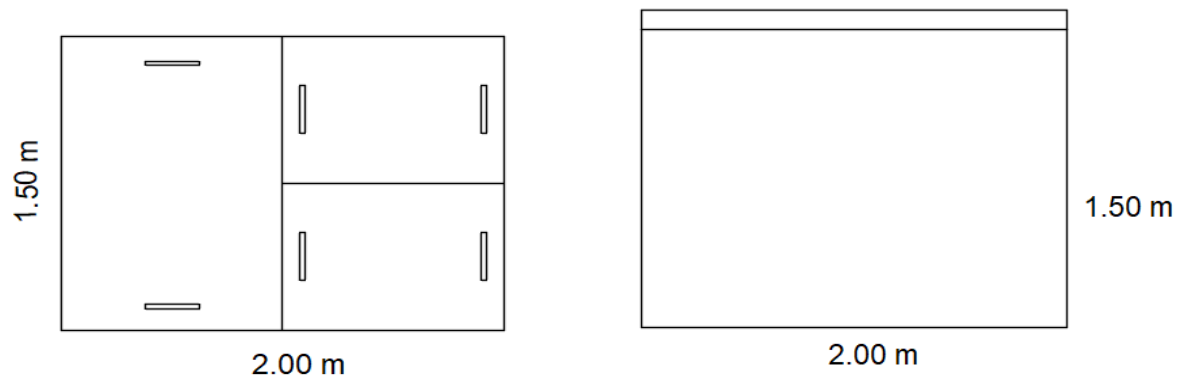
Esquema en Planta y Perfil de la Cámara de Reunión Existente.
